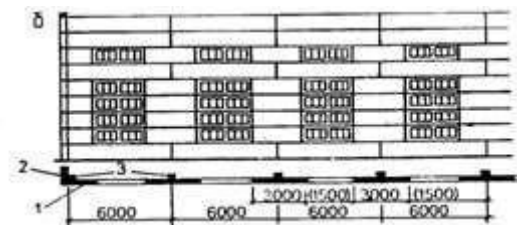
Панелі із легких бетонів і залізобетону:
